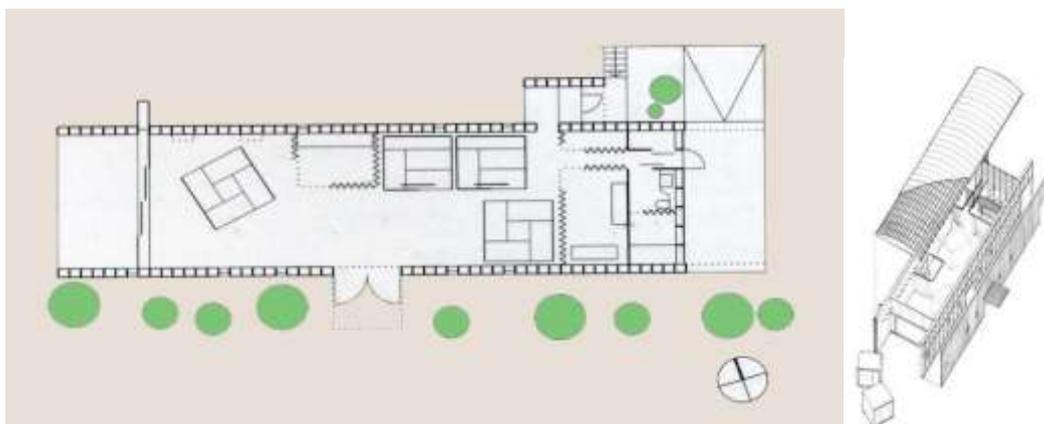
Projeto Naked House: planta e axonometria (Disponível em: SCHITTICH, 2001).
